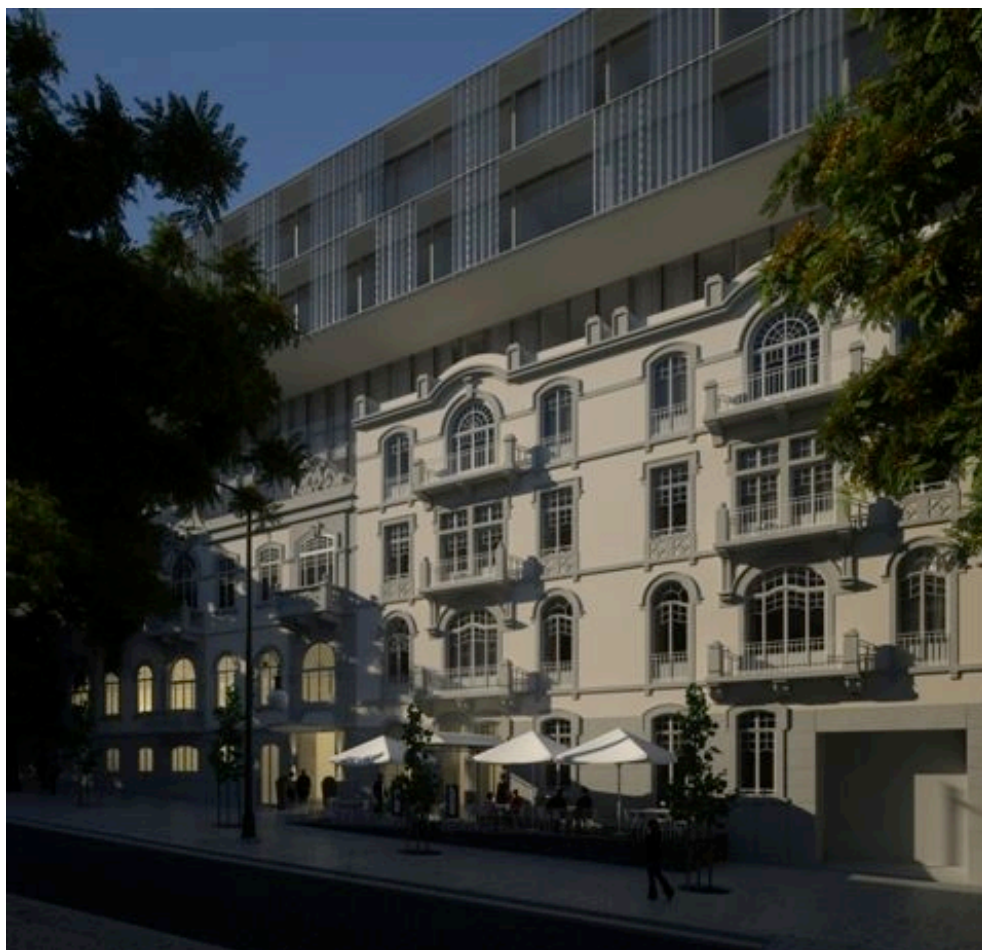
| Desenho da Fachada Principal (Rua Rosa Araújo)
